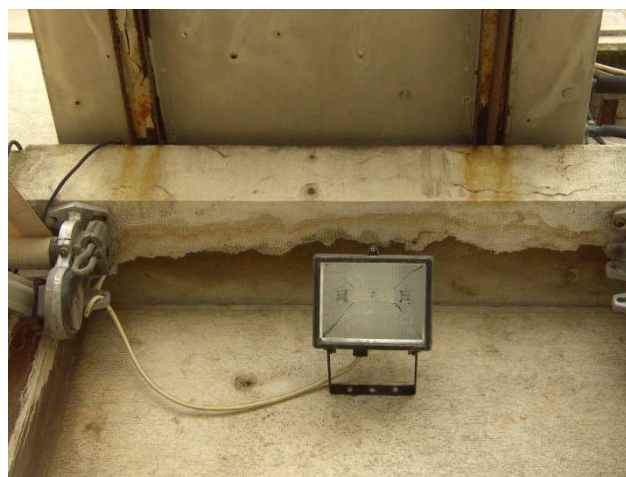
Tinción del voladizo del aplacado de piedra caliza por la oxidación de los elementos metálicos empleados para la sujeción de los aparatos de aire acondicionado de los locales comerciales
